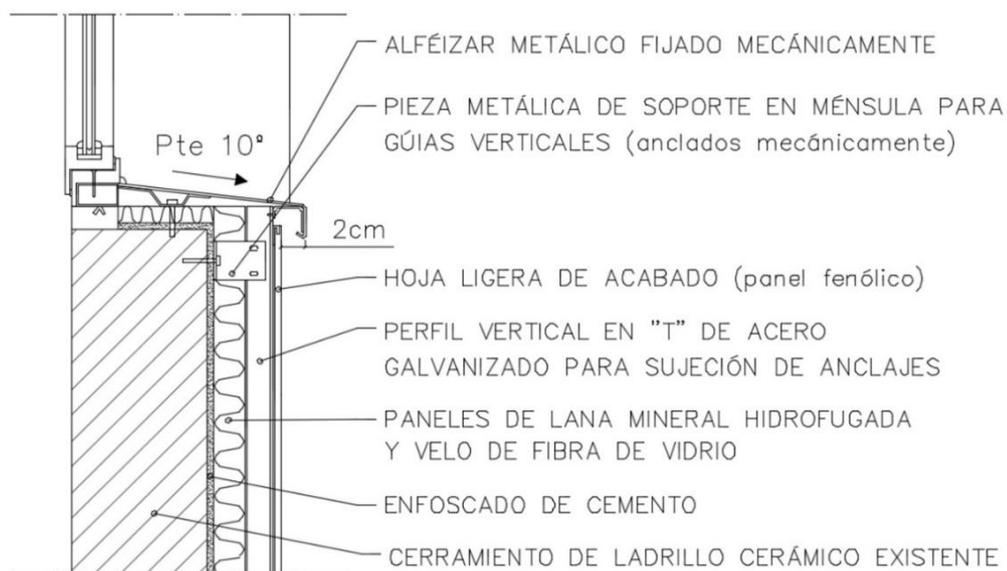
Detalle de alféizar en sistema de fachada ventilada. Fuente: elaboración propia
